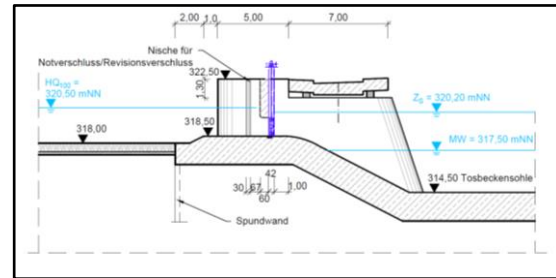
teiloffene Bauweise mit Staubalken und Brücke
